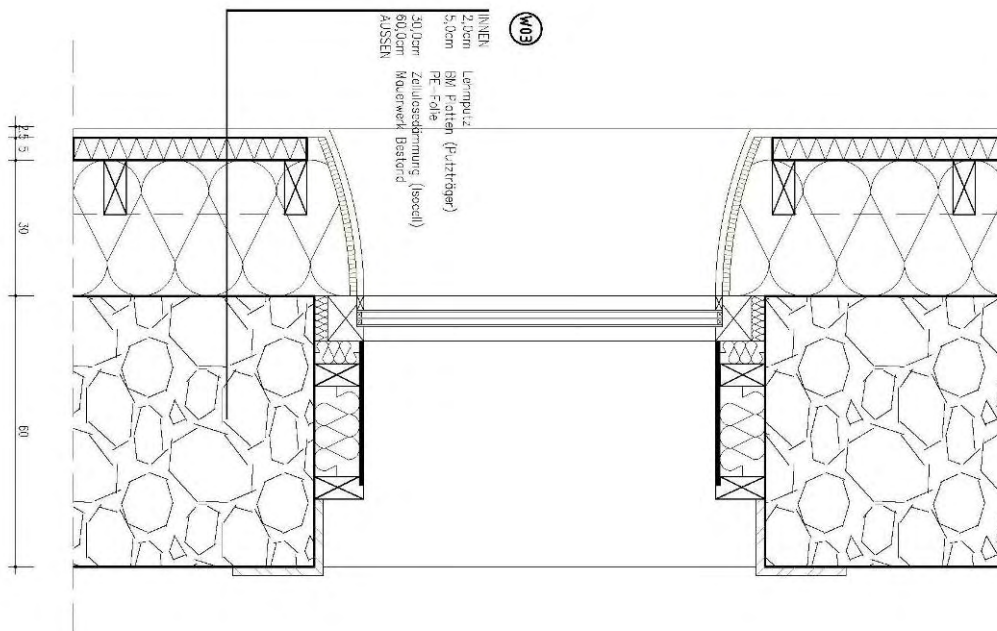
Detail Innendämmung mit Fensteranschluss
